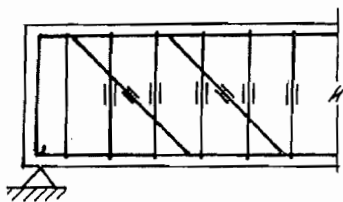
钢筋混凝土梁的弯起钢筋和钢箍上的应变测点
